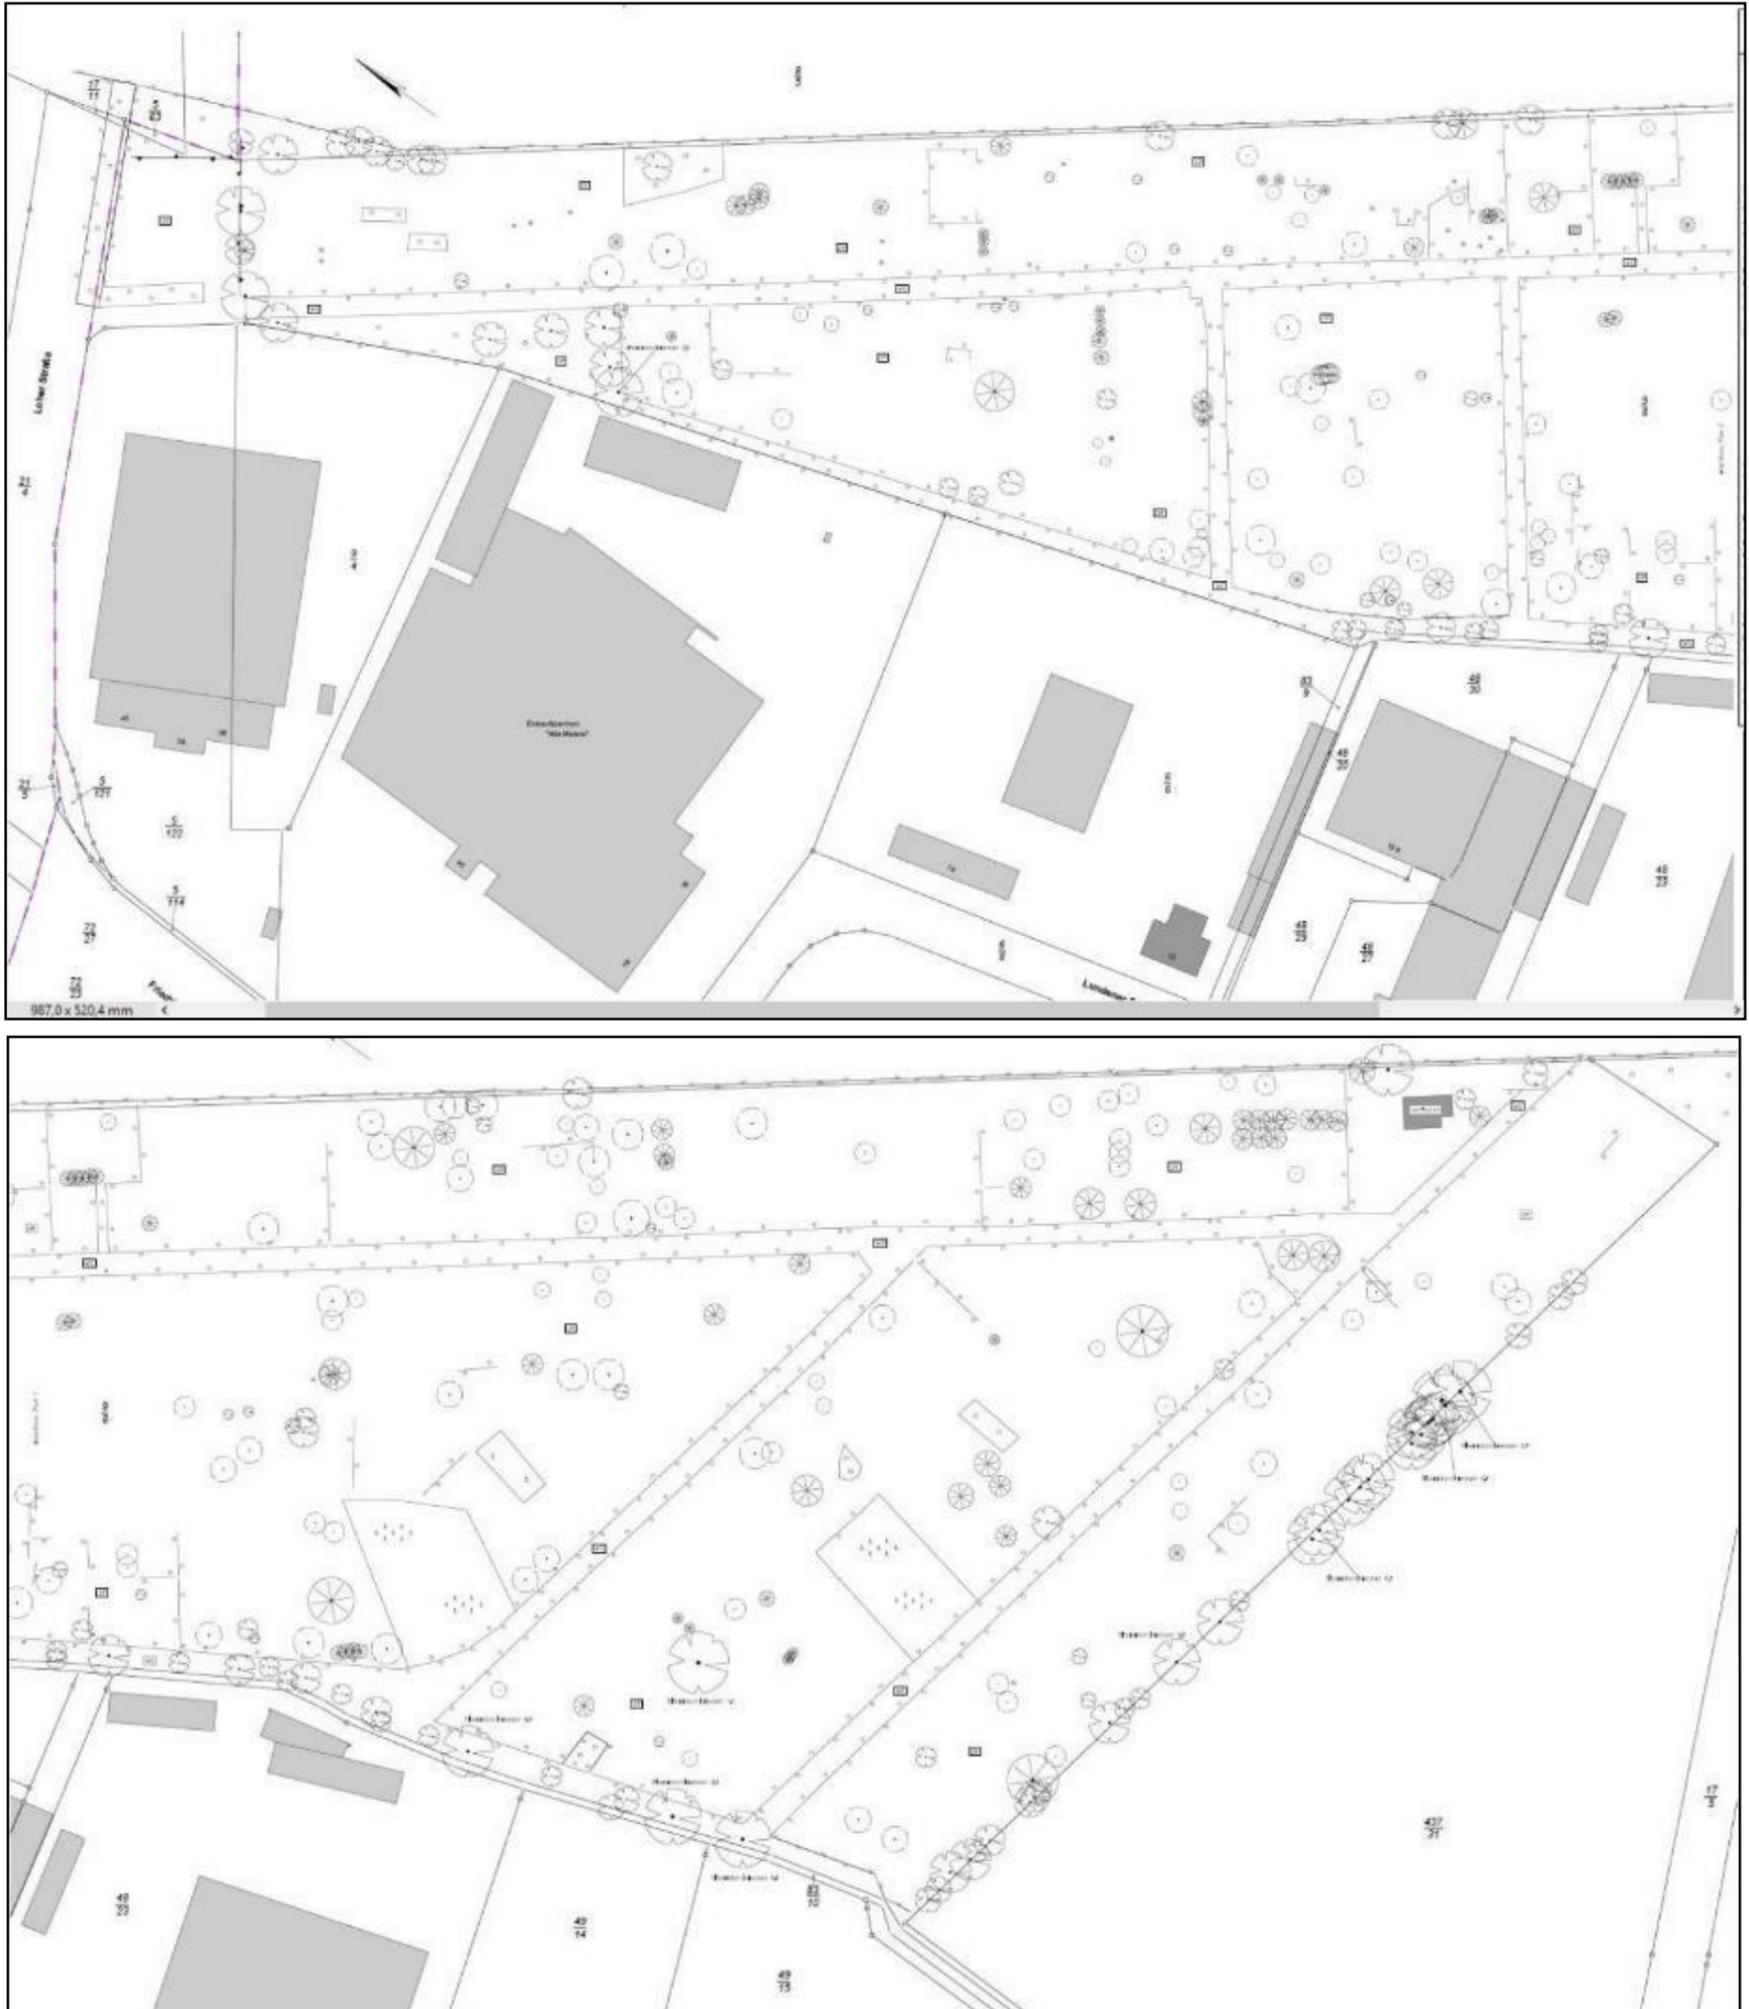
Bestandslageplan der Gehölzstrukturen im Plangebiet (Ehemalige Kleingartenanlage Erholung, oben: nördlicher Teilbereich, unten: südlicher Teilbereich, nach OVERATH UND SAND 2012)
